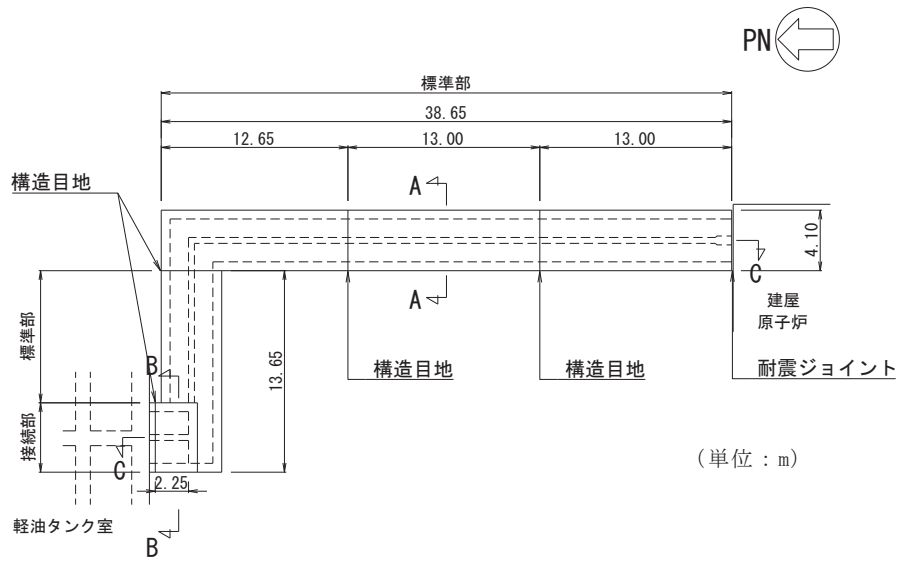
軽油タンク連絡ダクト平面図（詳細）
